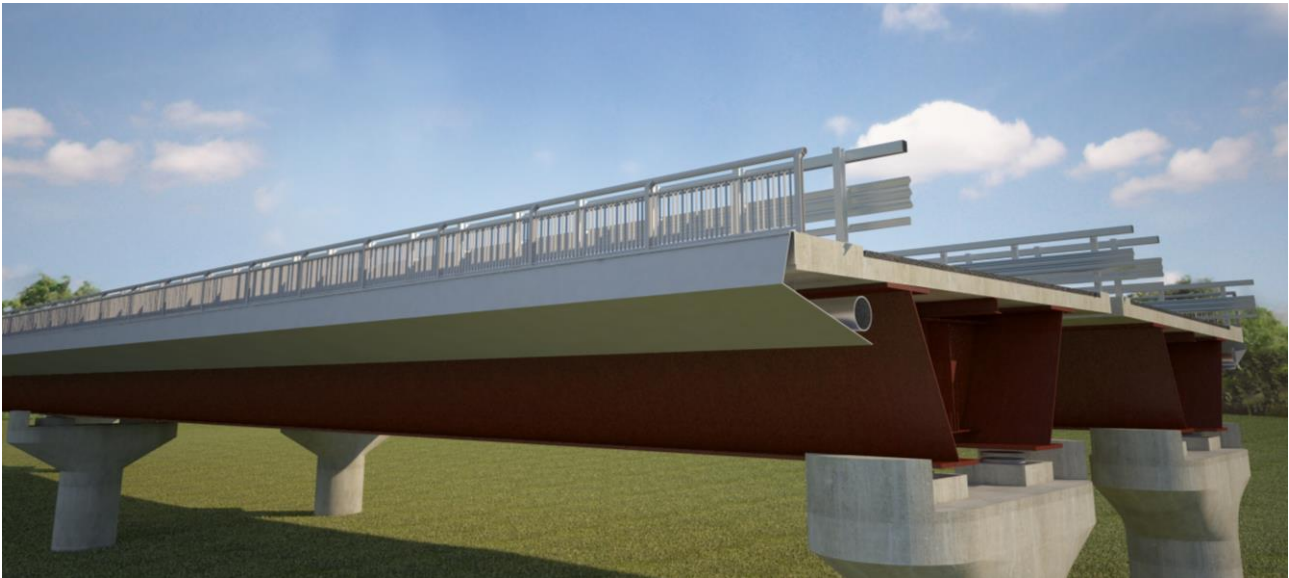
SPACCATO DI DETTAGLIO DELLE SOLUZIONI ARCHITETTONICHE PER IL VIADOTTO
